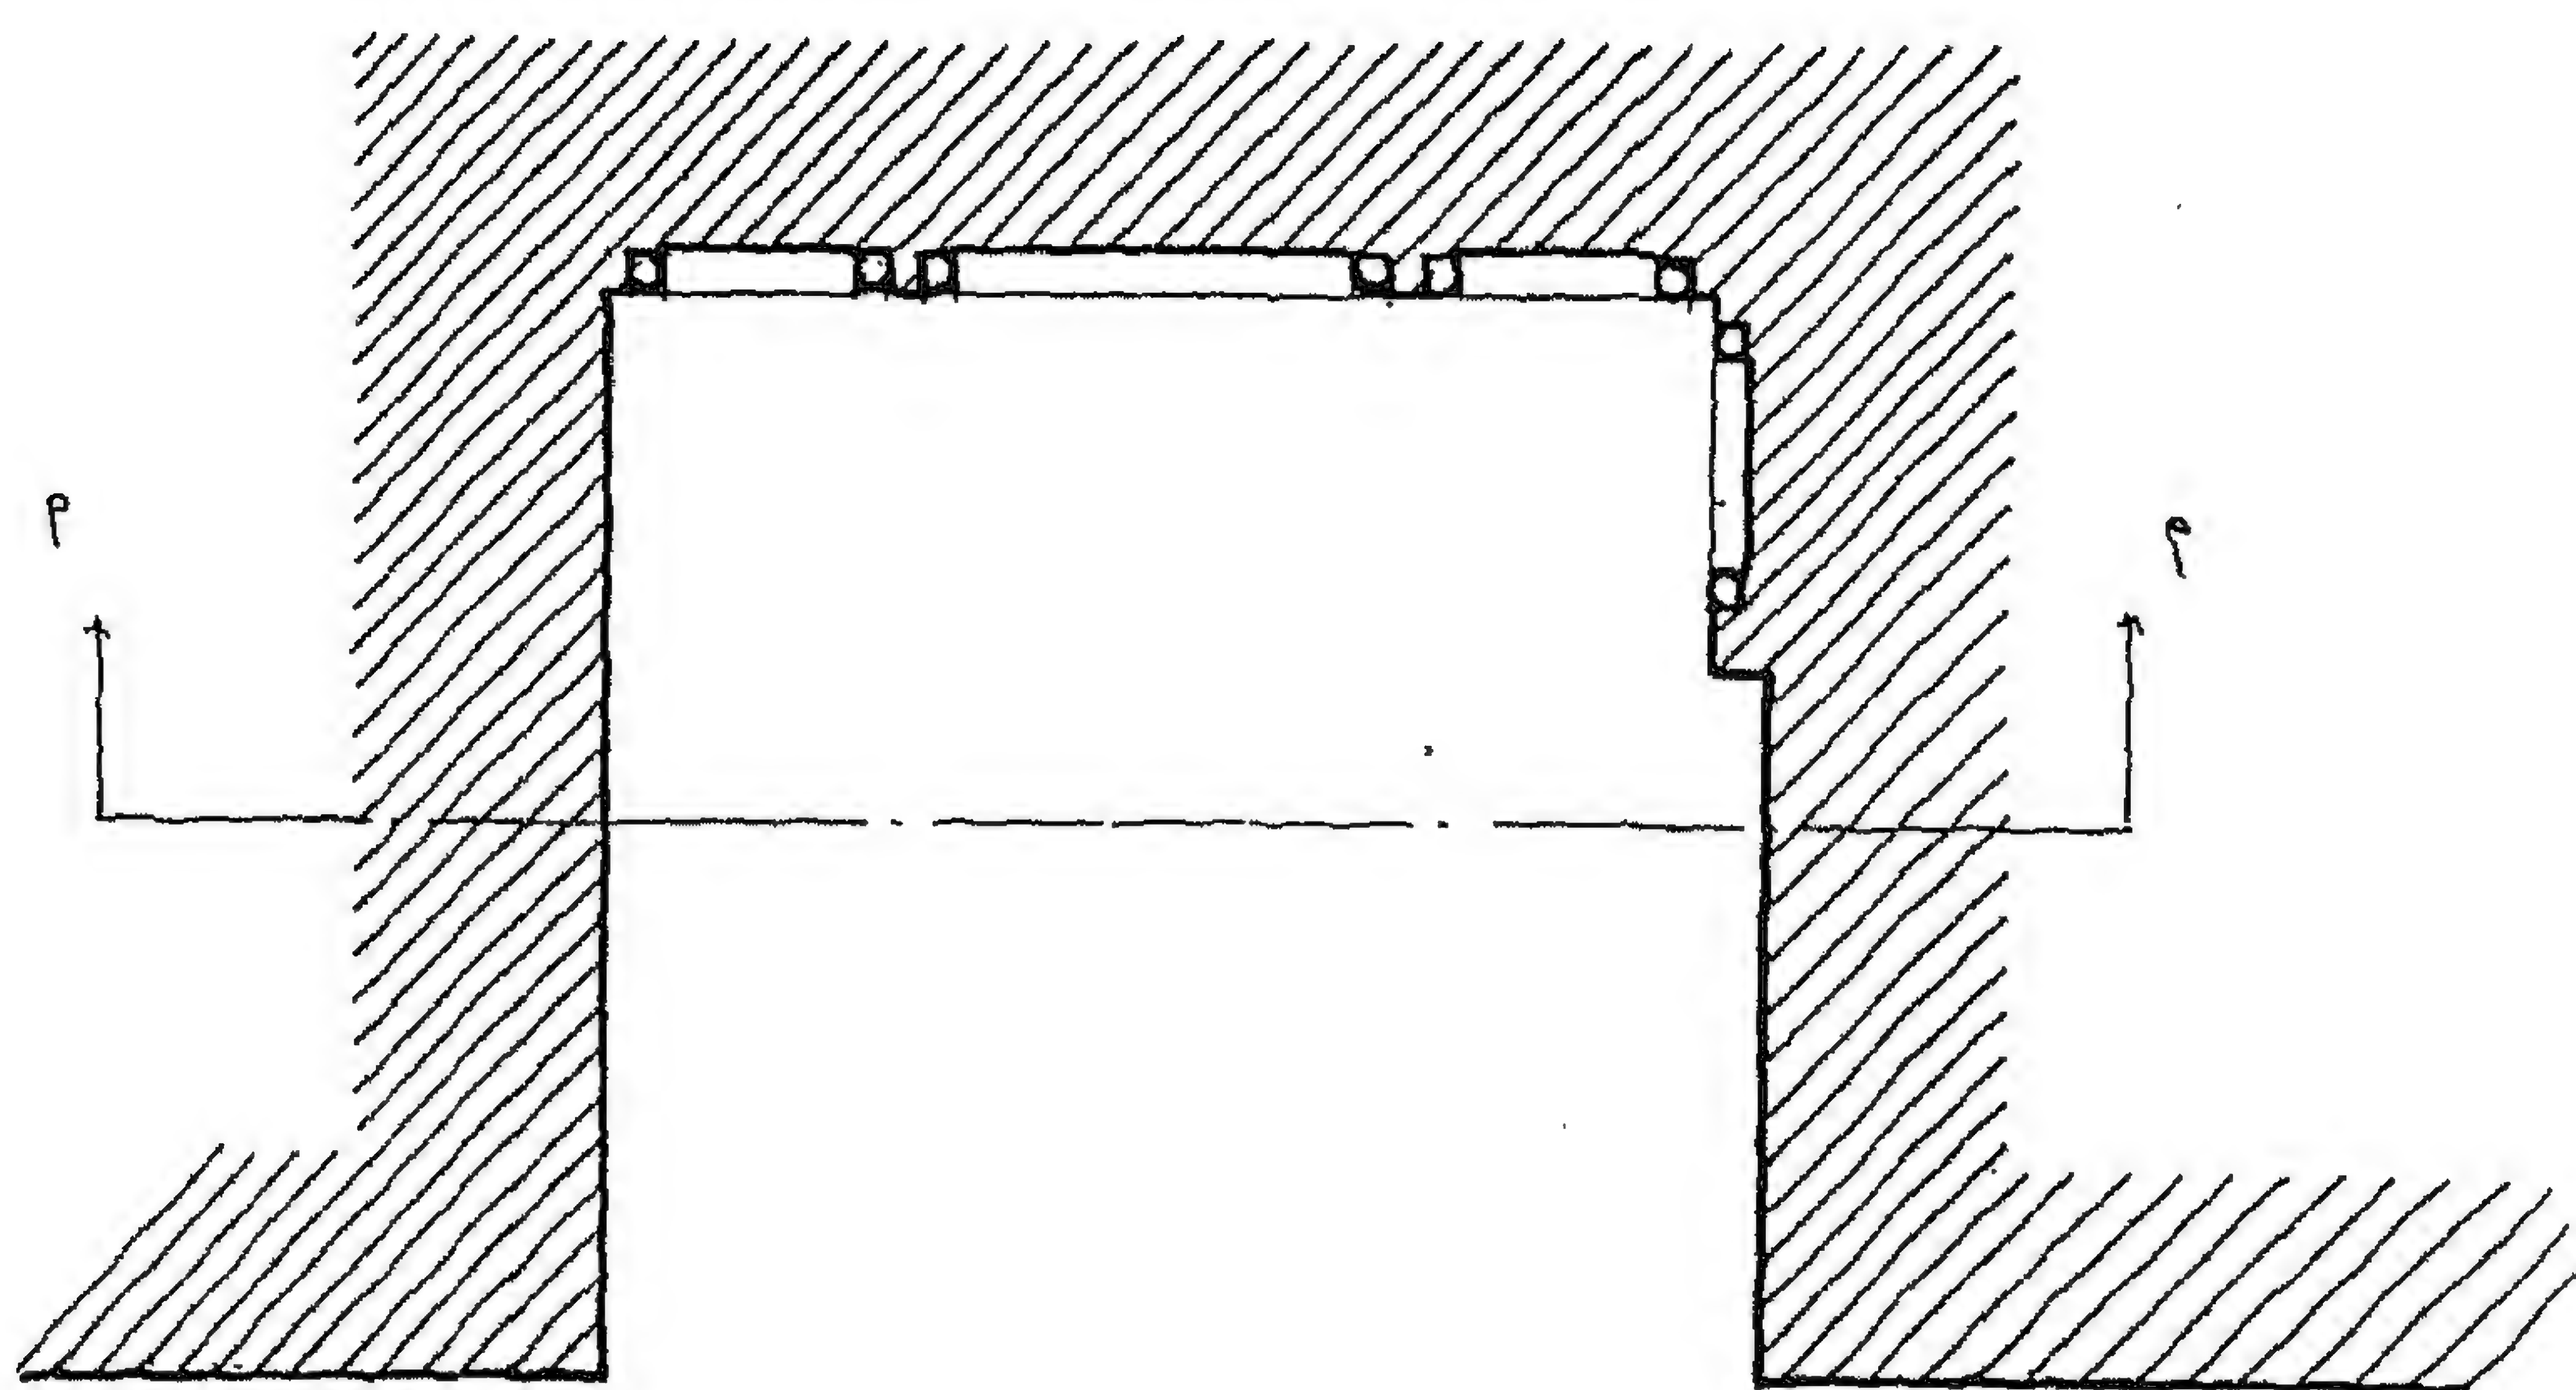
مسقط أفقي لحوض مدرسة أم السلطان شعبان
